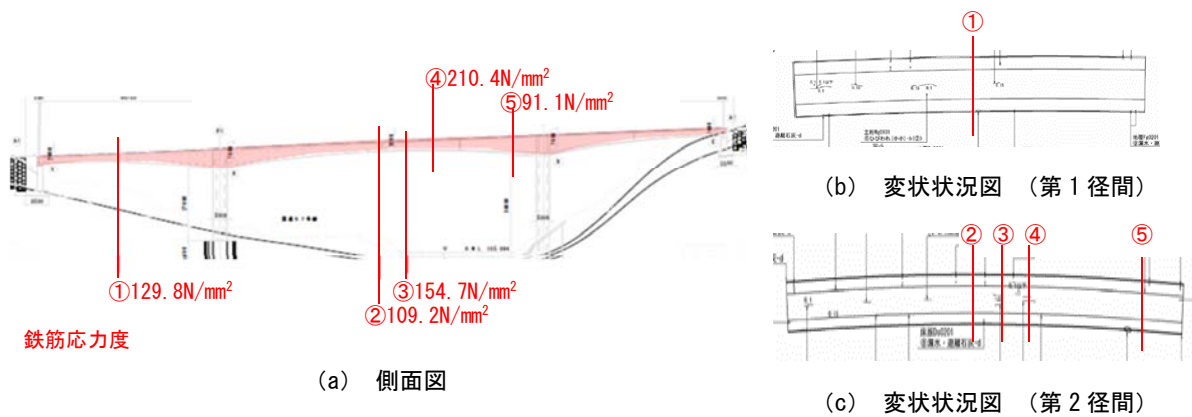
鉄筋応力度及び算出断面位置 (橋梁 No. 19)
